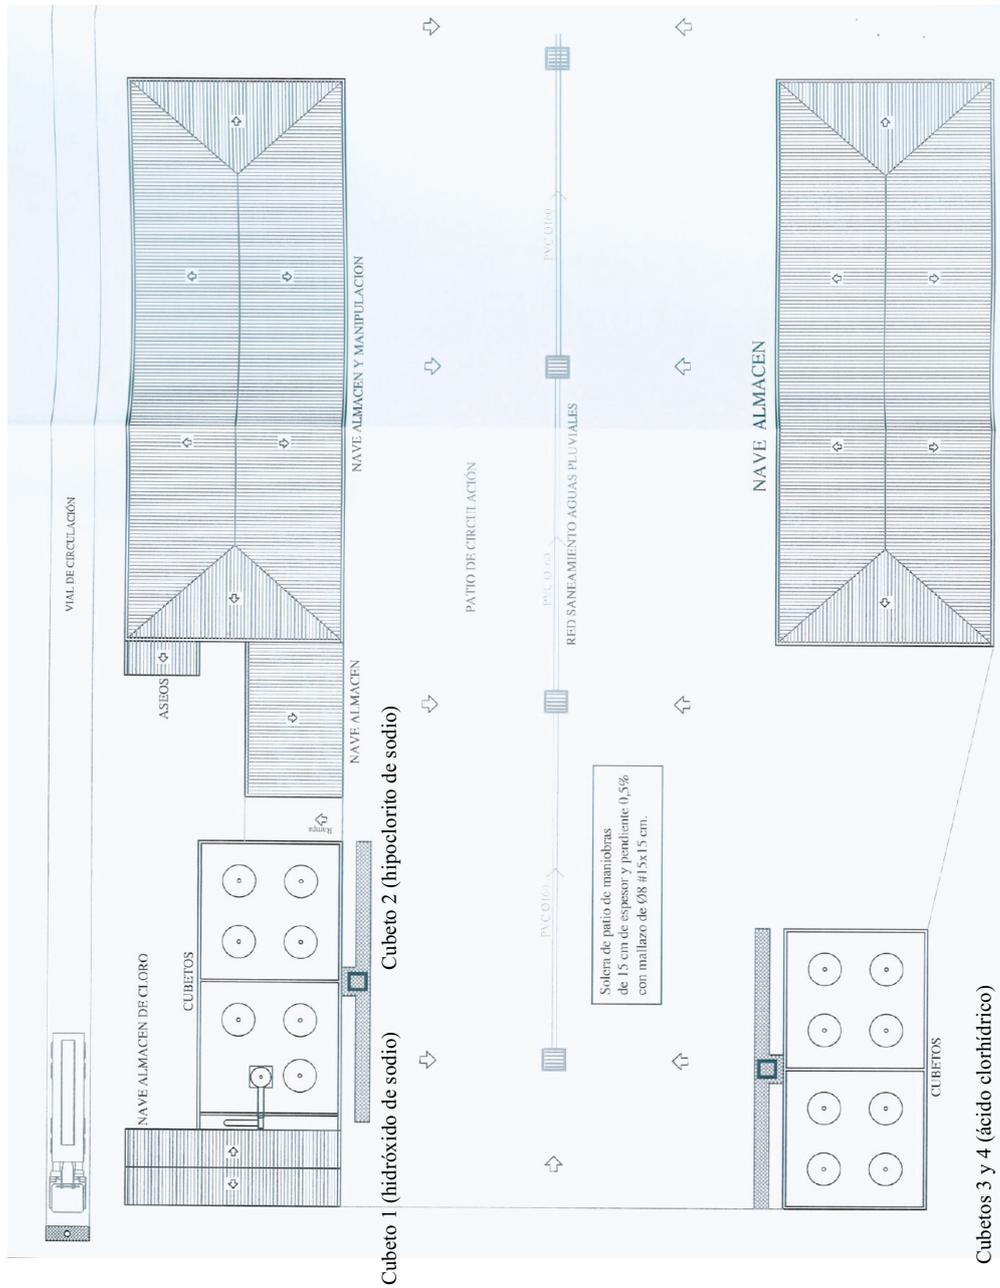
Plano en planta de las instalaciones. Se muestra red de saneamiento de aguas pluviales.
